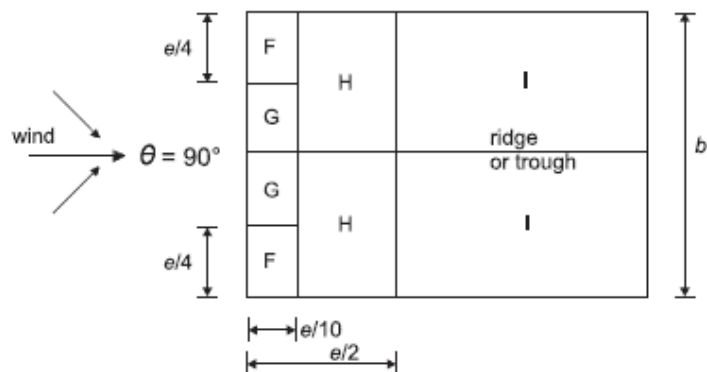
Esquema de áreas para coberturas com vento longitudinal [4]
